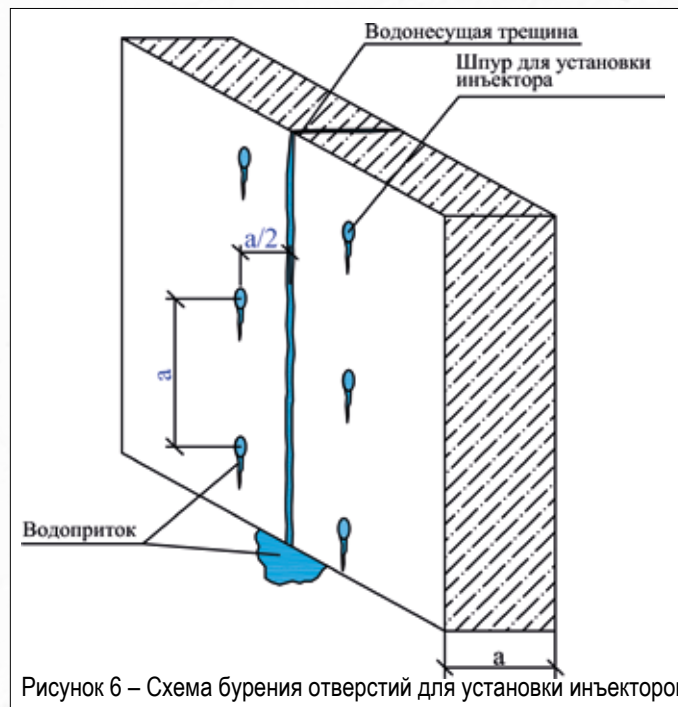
Схема бурения отверстий для установки инъекторов
